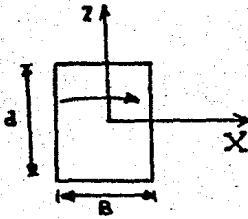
Columna de madera con apoyos diferentes en dos planos de acción.
